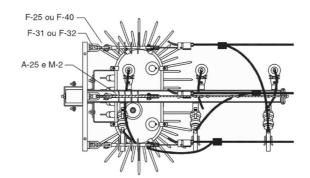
Estrutura CE3 TR - Poste de concreto de seção DT ou de madeira
